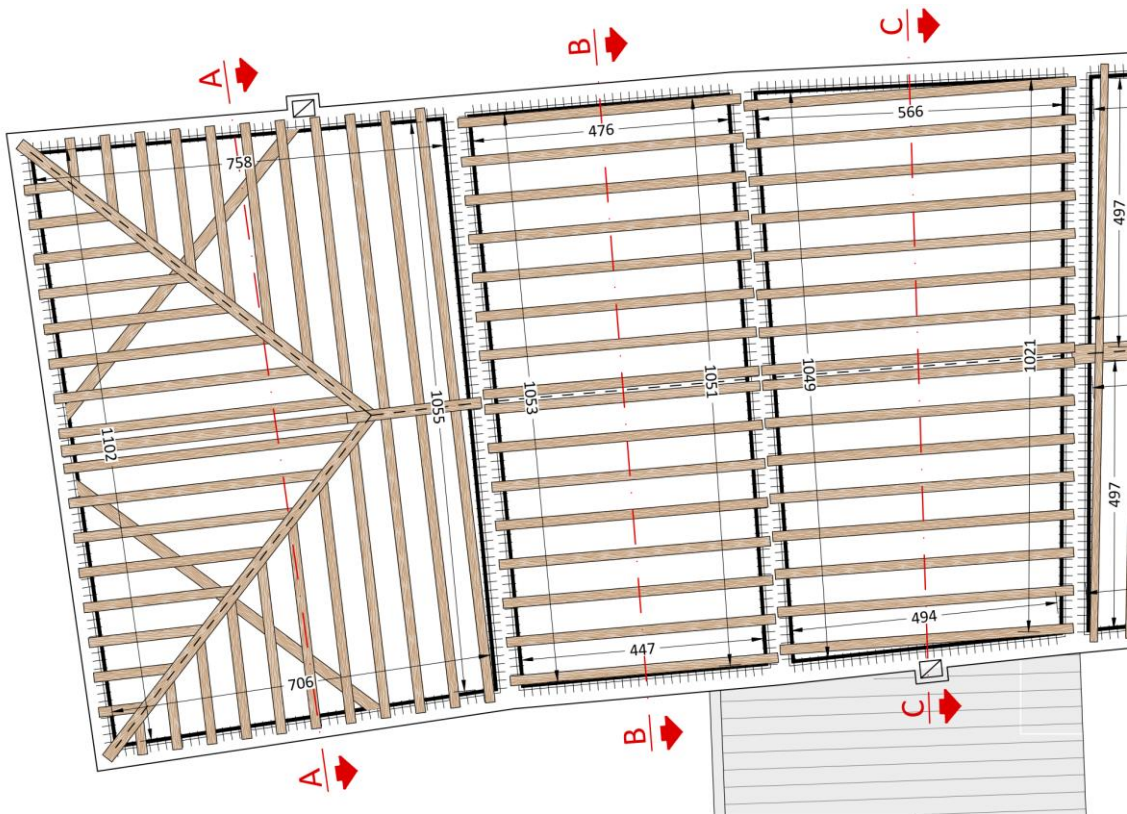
Pianta copertura dei blocchi A,B,C
